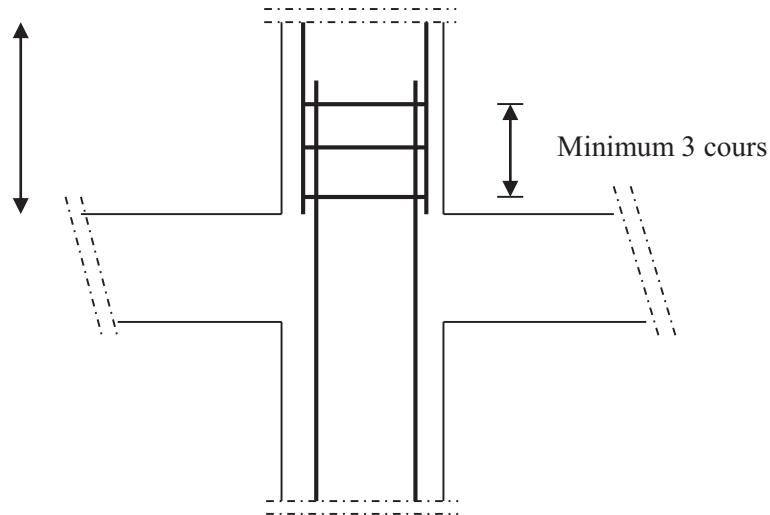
Les armatures transversales dans la zone de recouvrement
